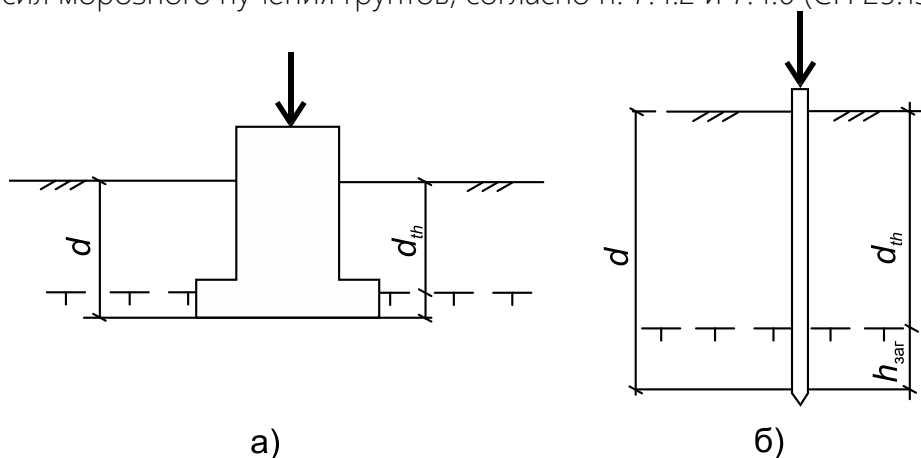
К определению глубины заложения фундамента; а – столбчатый фундамента; б – свайный фундамент
